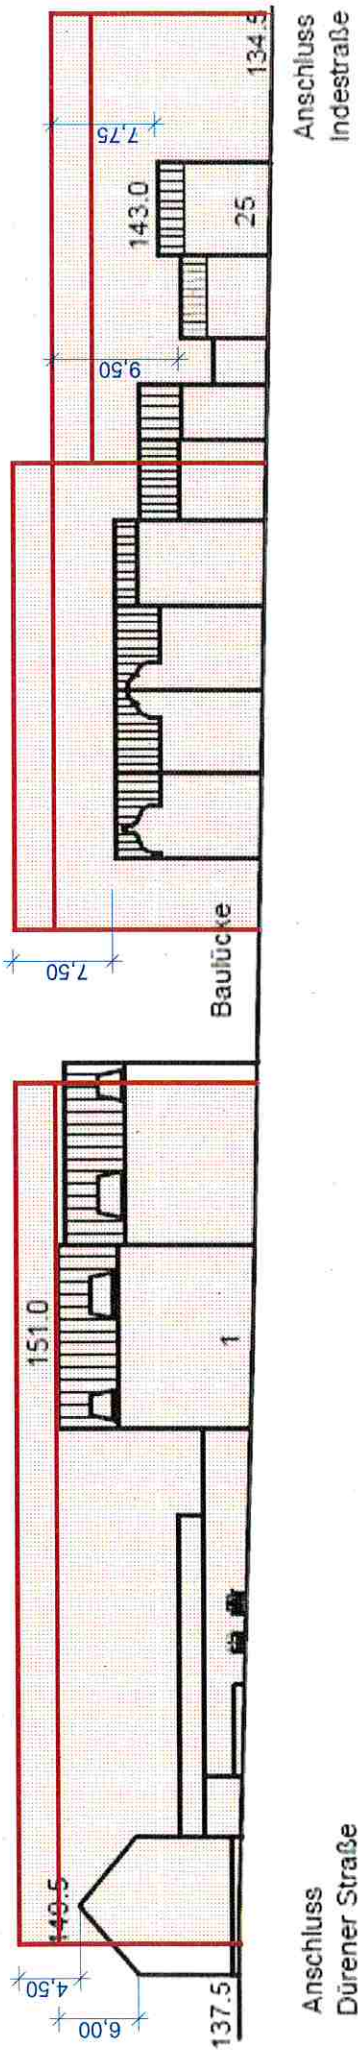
Schematische Fassadenabwicklung Peilsgasse, Höhenangaben näherungsweise in m ü NHN [Quelle: Stadt Eschweiler]
